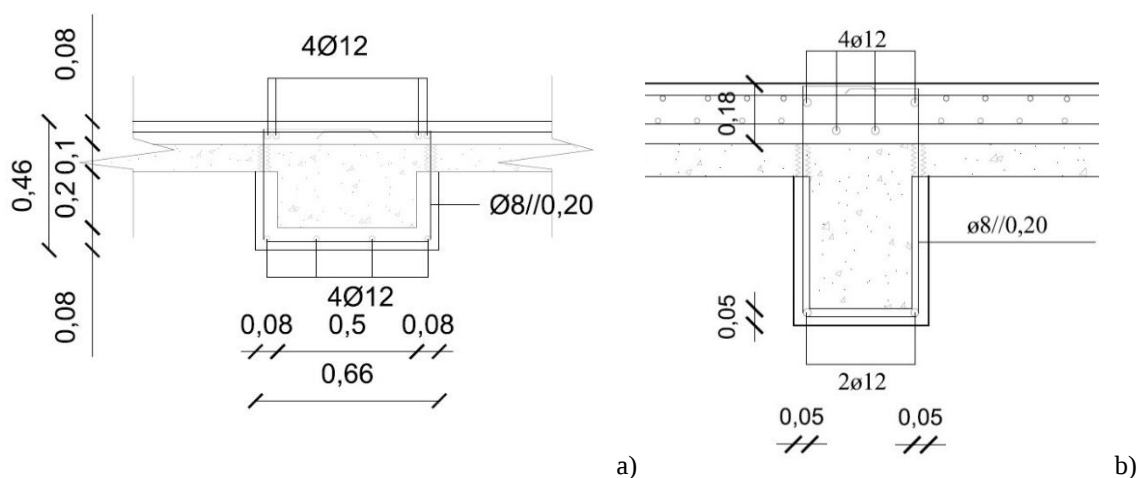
Solução de reforço de vigas: a) no teto do piso -1; b) no teto do piso 0
